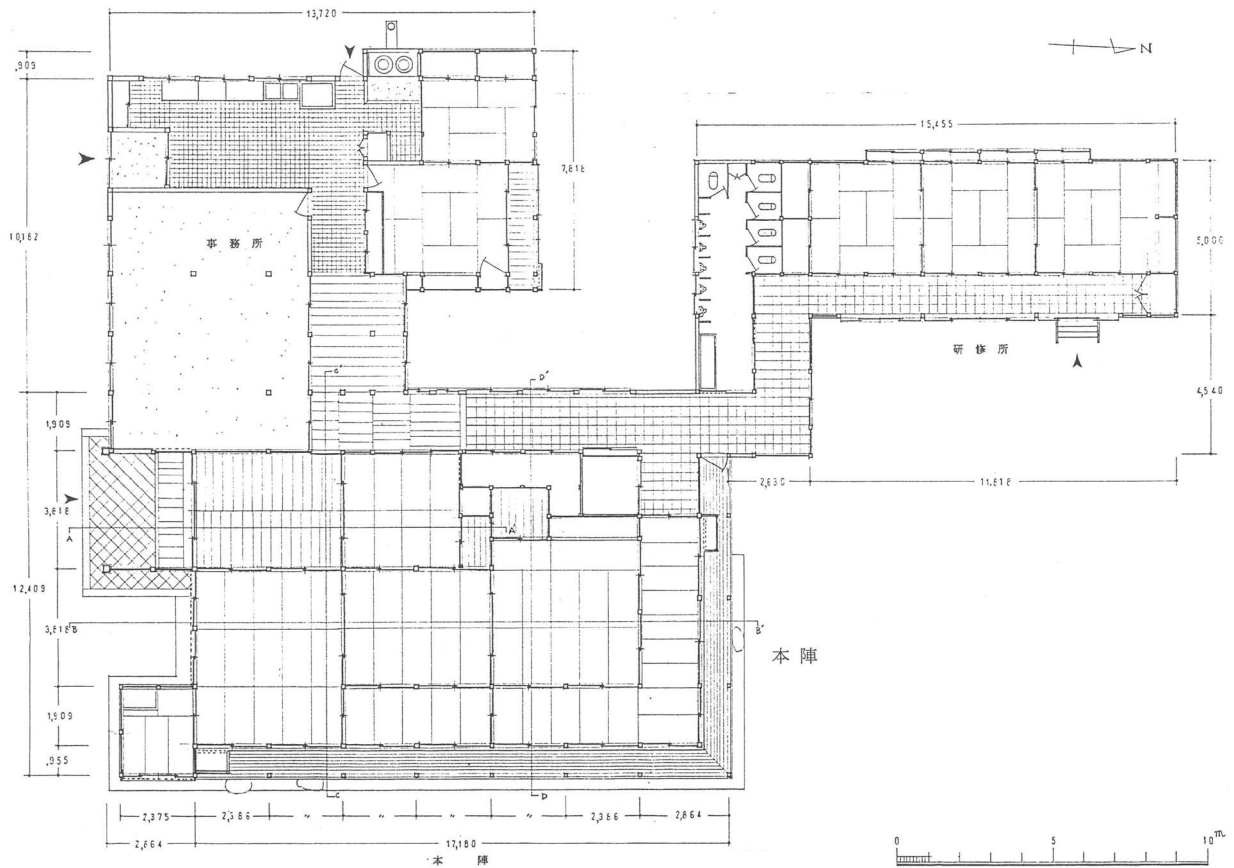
本陣 平面図 (平成 11 年保存修理時・修理前図面)
